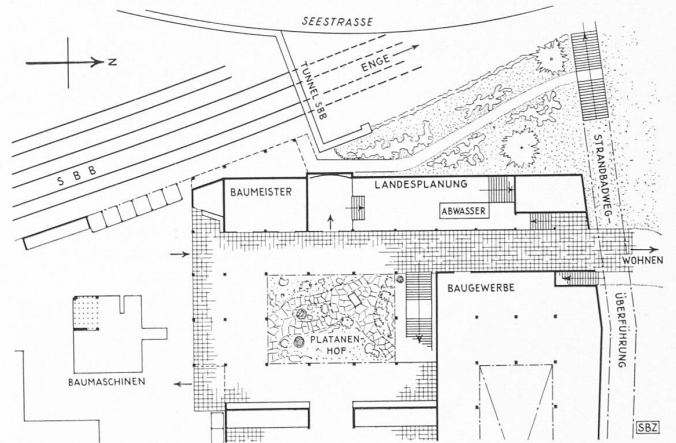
Erdgeschoss der Ausstellung «Plan und Bau». — 1: 800
